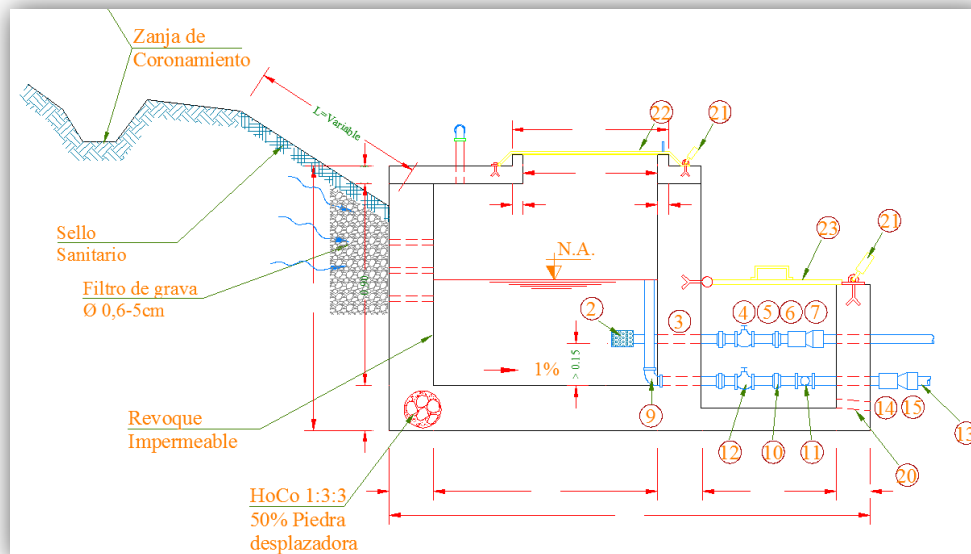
Detalle del dimensionamiento de una obra de toma tipo ladera
